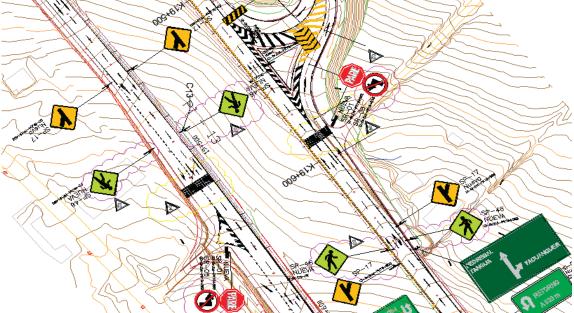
Trazado vial para puente peatonal Cebadal.
